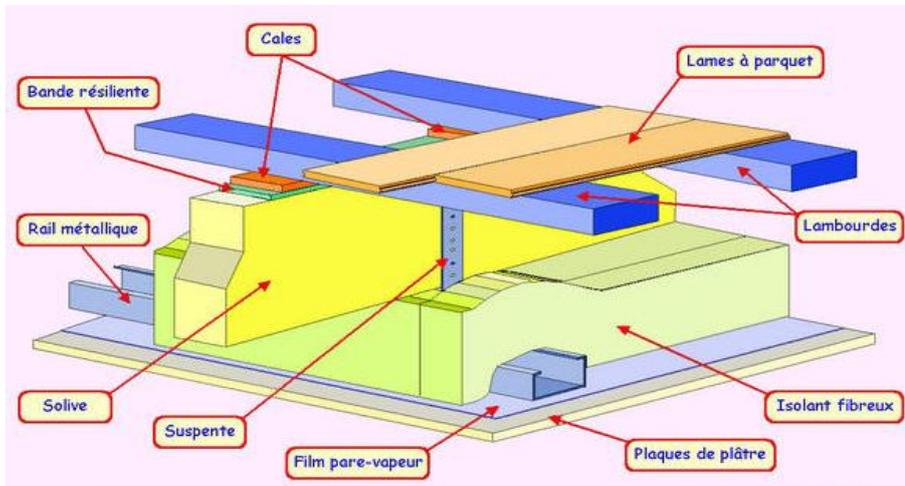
détail constructif du plancher utilisé. Source : Google image
